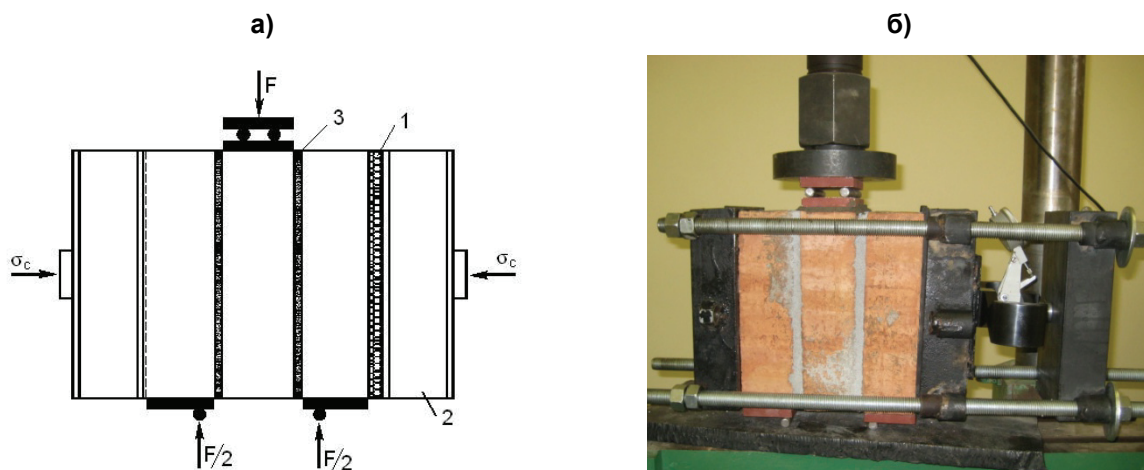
(а) схема и (б) общий вид испытаний опытного образца каменной кладки.
